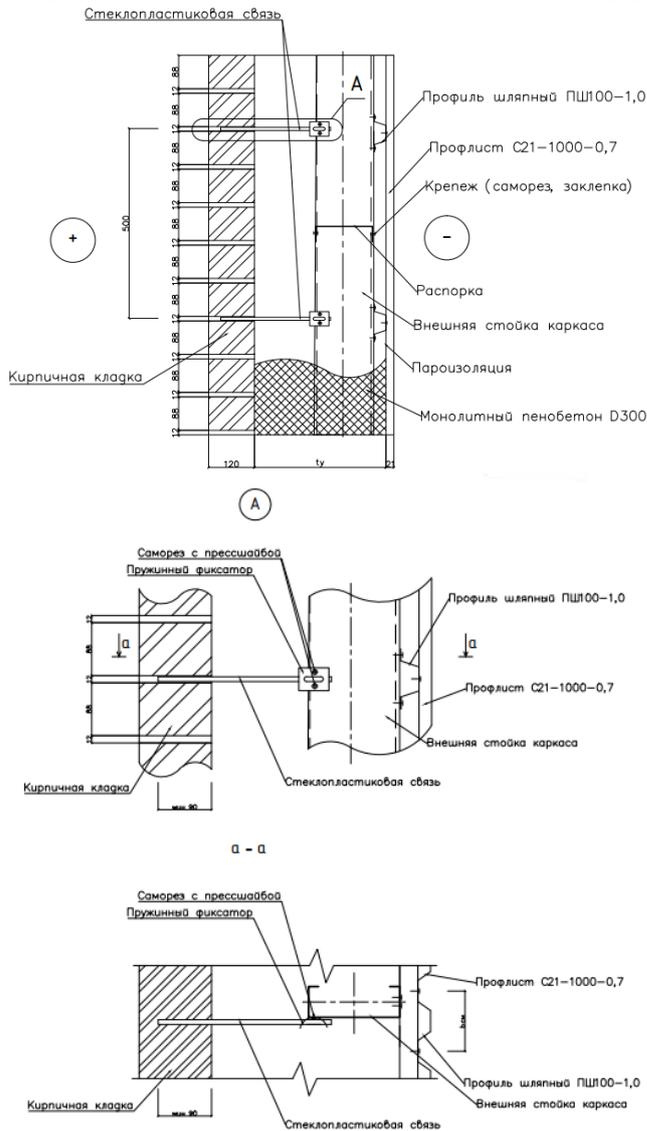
Конструкция фасадной системы из пенобетона и металлического профилированного листа применительно к стене из кирпича.
